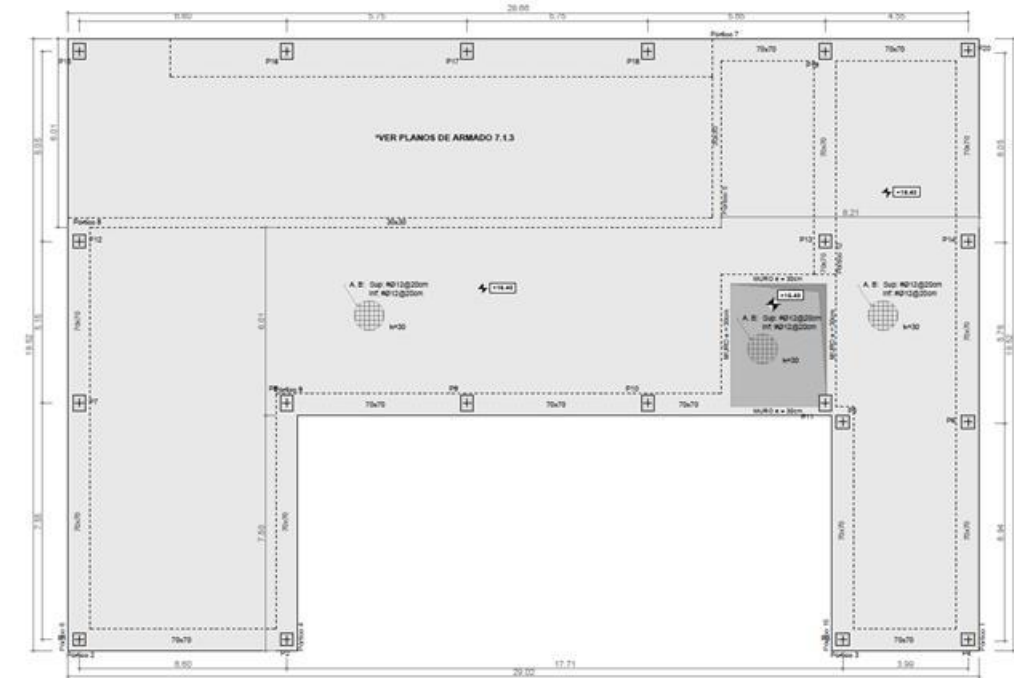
Losa de cimentación y zunchos de recrecido bajo alineación de pilares
